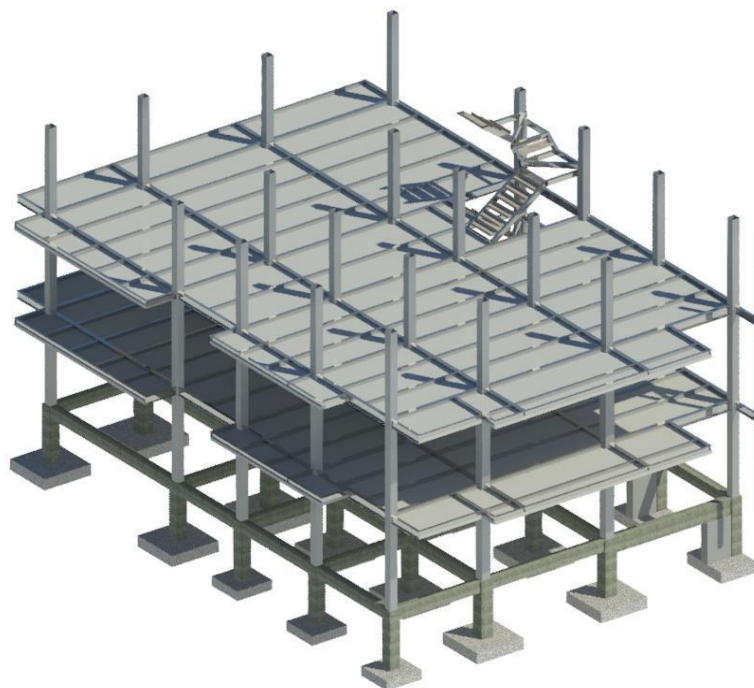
Render de Autodesk Revit Modelo Estructural en 3D Segunda Planta Alta
